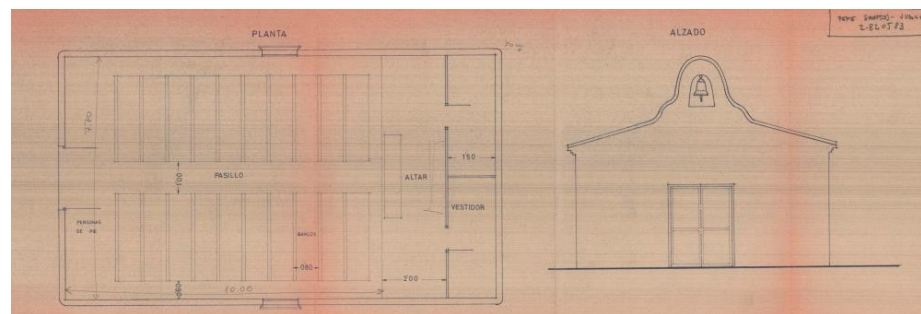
Lámina que incluye la planta y el alzado del primer proyecto de la Ermita
